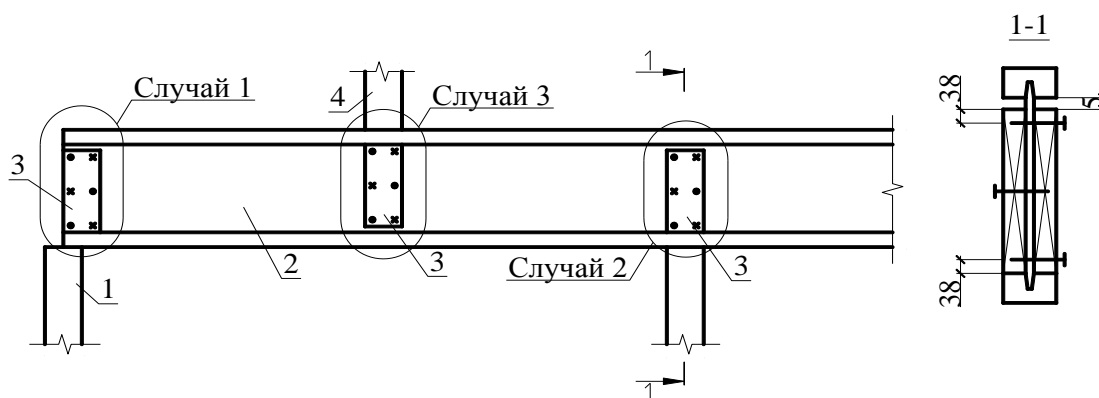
Варианты усиления стенки балки в местах передачи сосредоточенных нагрузок: 1 - опора; 2 - двутавровая балка; 3 – элемент усиления; 4 - сосредоточенная нагрузка.
